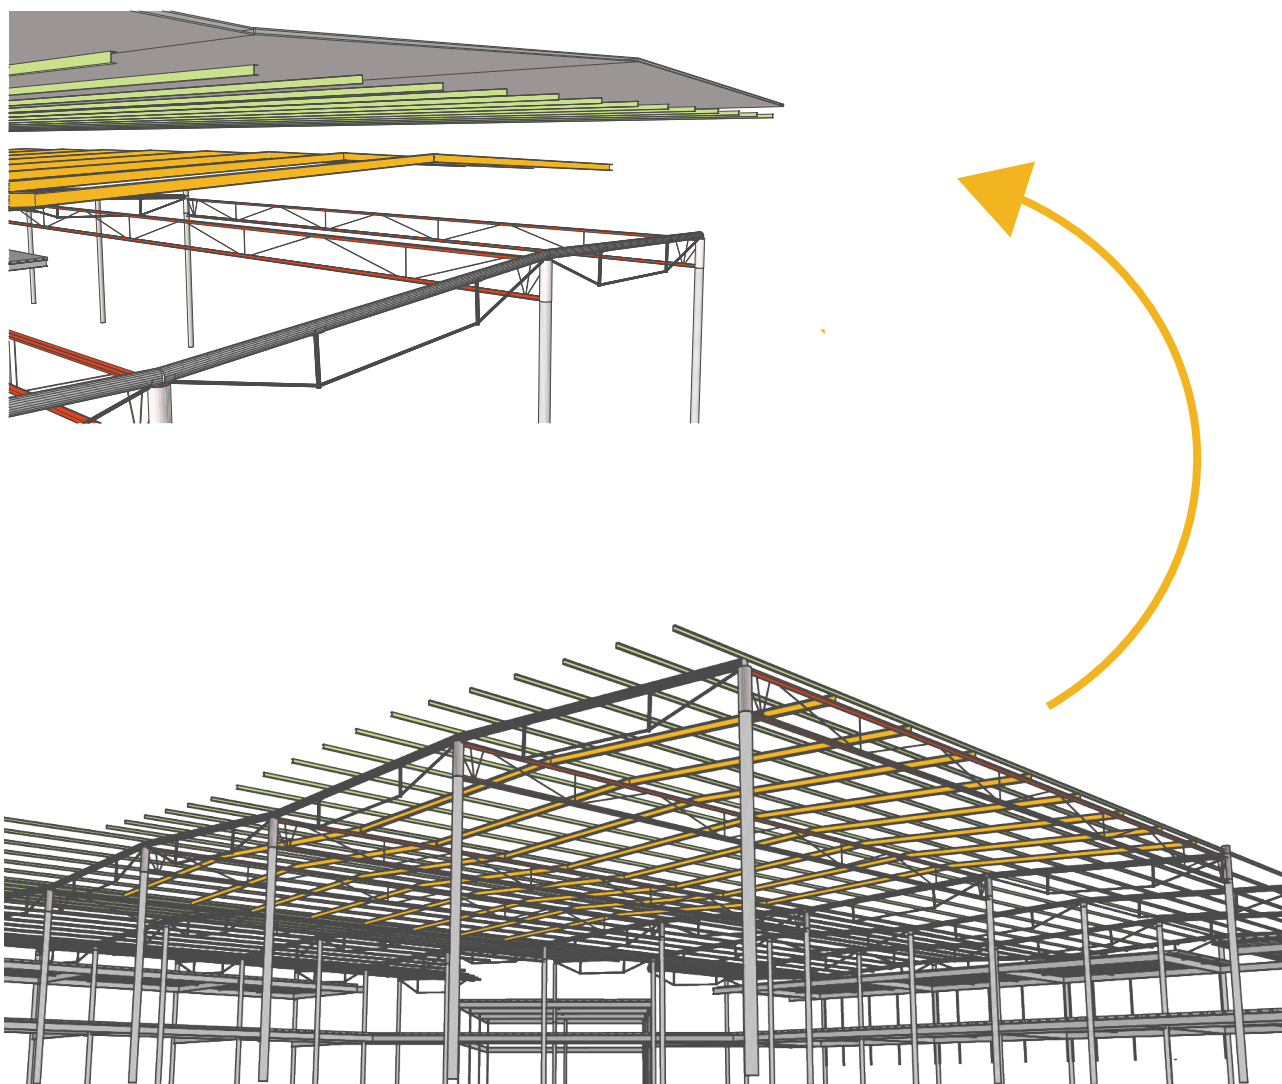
Detalhe laje Steel Deck. (Fonte: Edifica.UFV)
